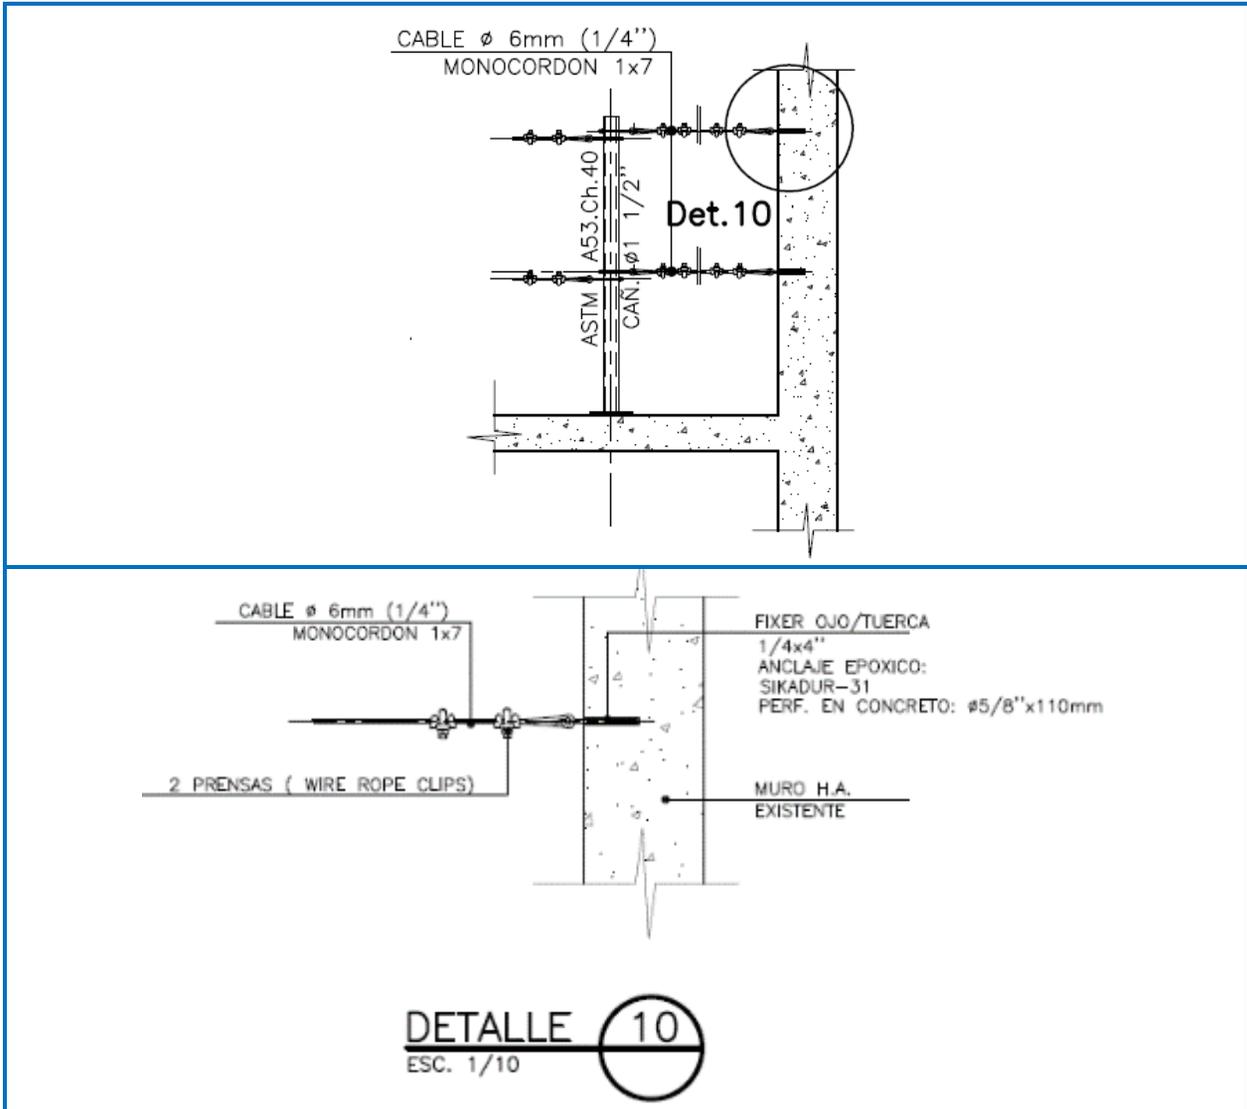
Sistema de protección conectable anclado a un muro estructural (medidas en cm)- Elaboración Propia
